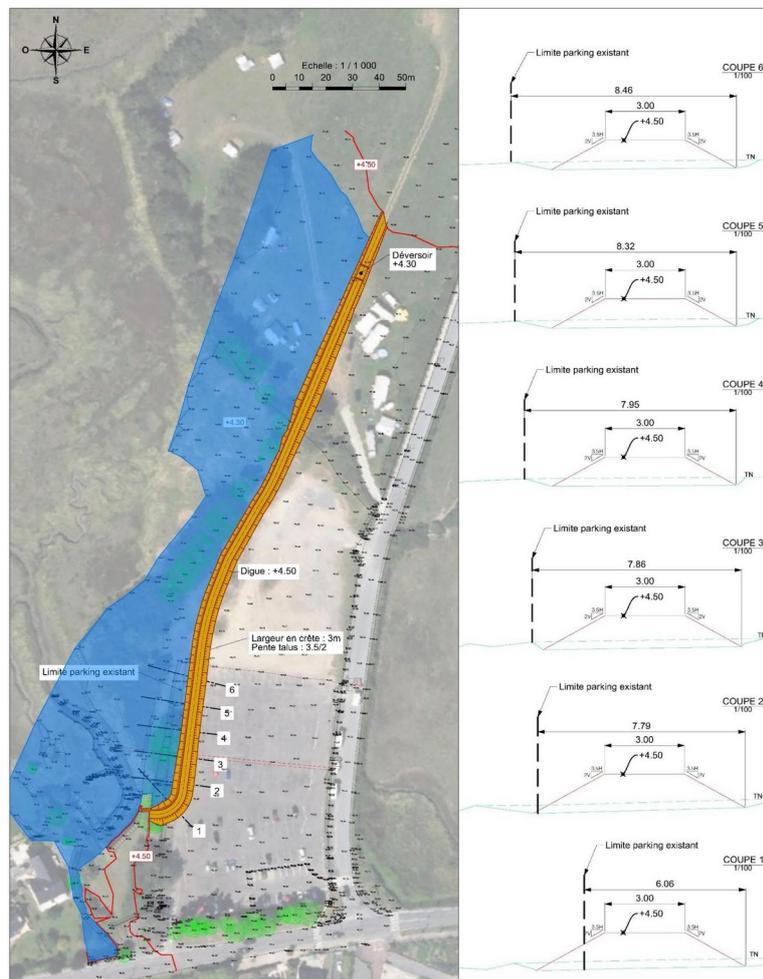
Vue en plan et coupes de l'ouvrage ; source : dossier
